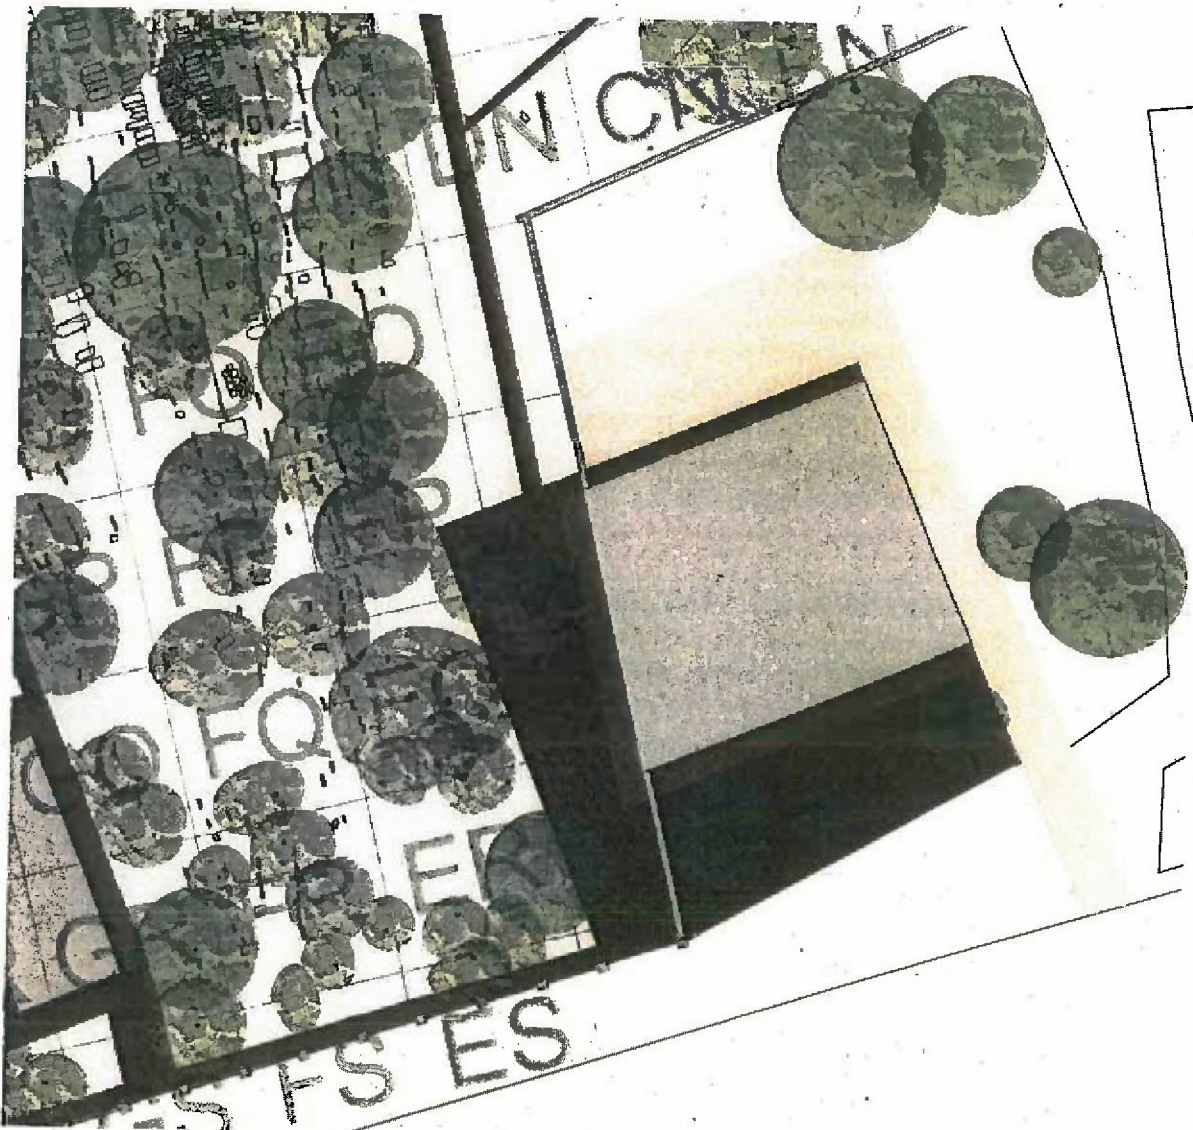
Planausschnitt Besucherzentrum mit angrenzenden Platzflächen
